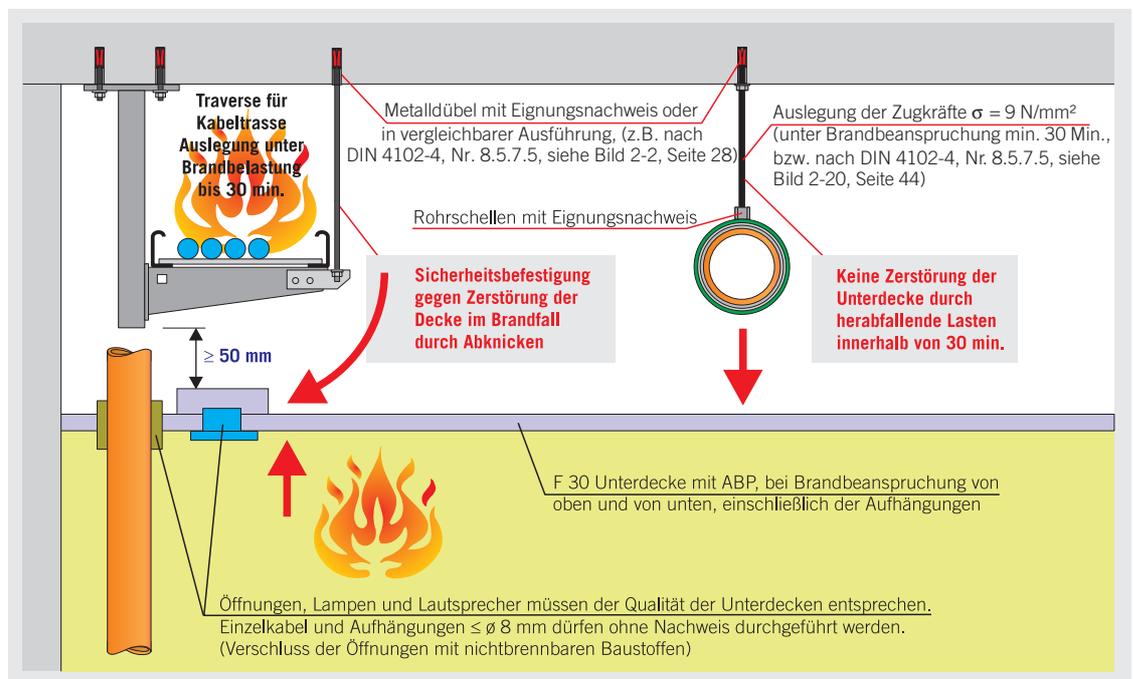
Befestigung von Leitungsanlagen oberhalb von F 30 Unterdecken
